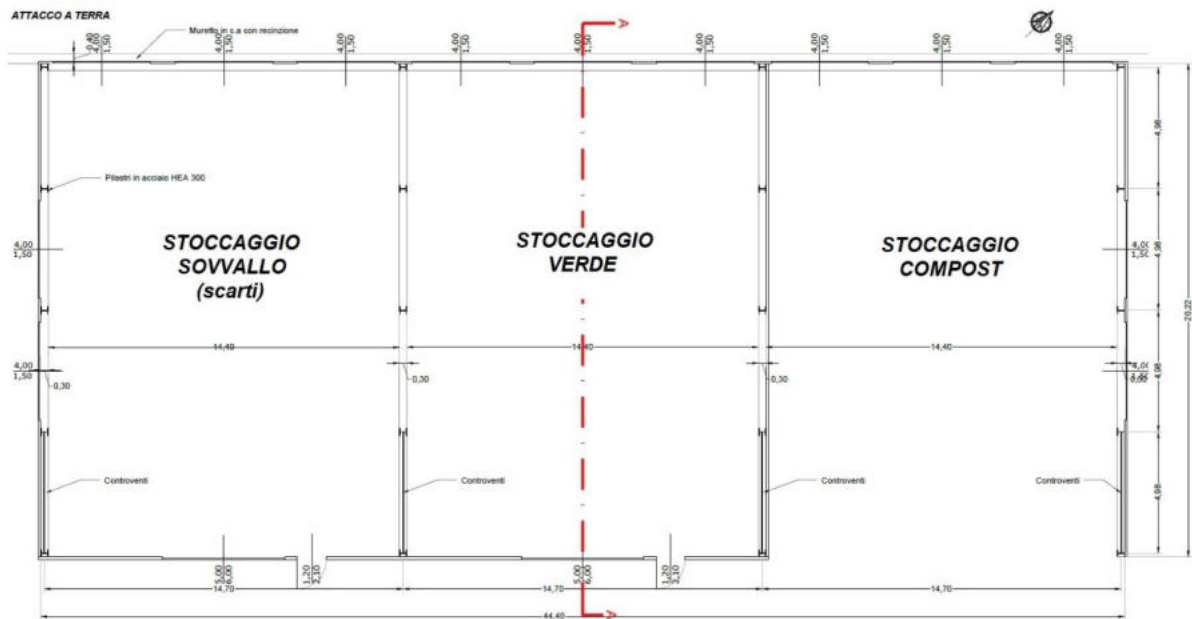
DETTAGLIO PIANTA DI PROGETTO – TETTOIA DI STOCCAGGIO MATERIALI
